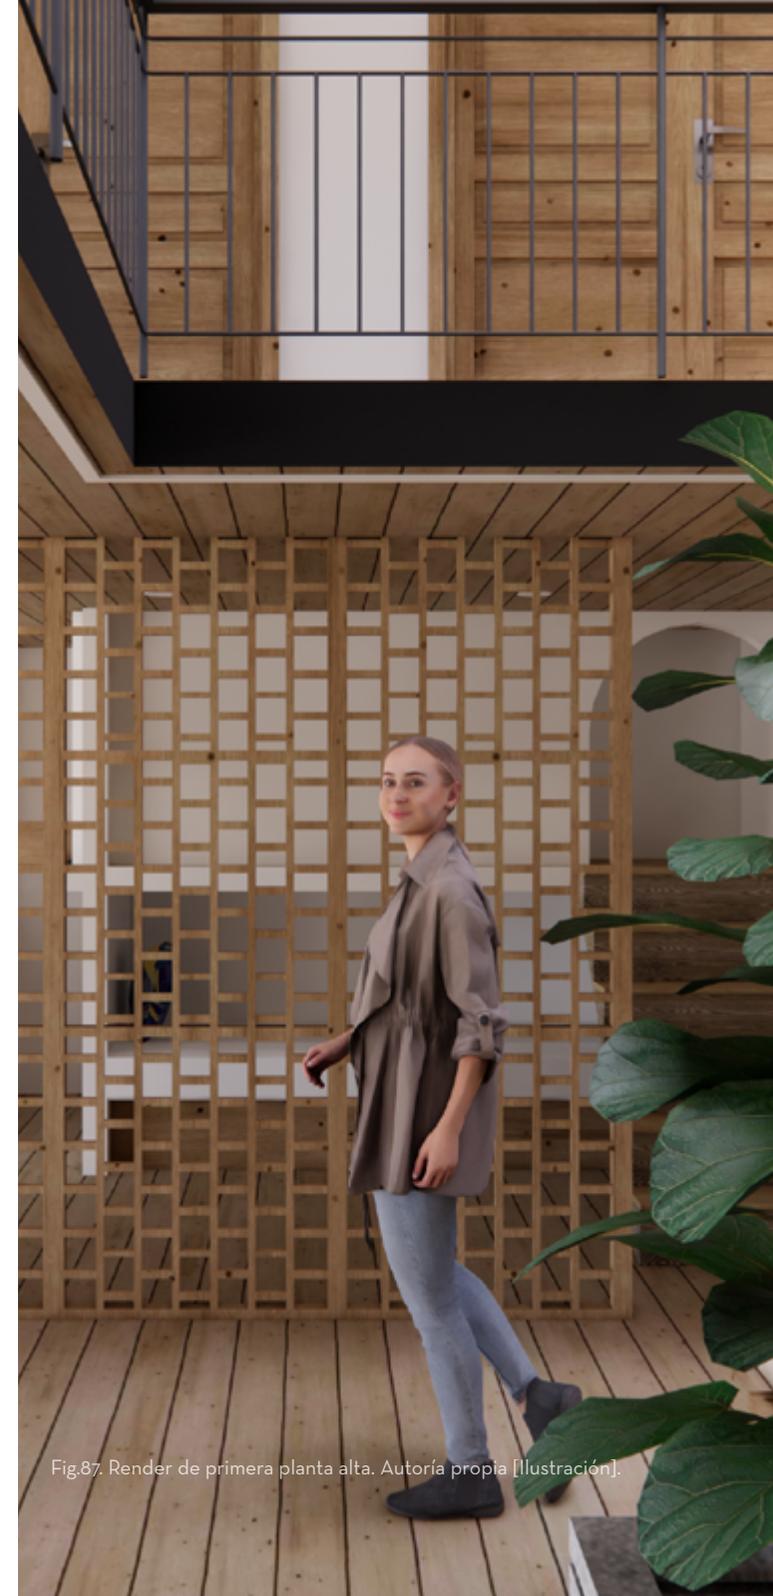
Render de primera planta alta. Autoría propia [Ilustración].
